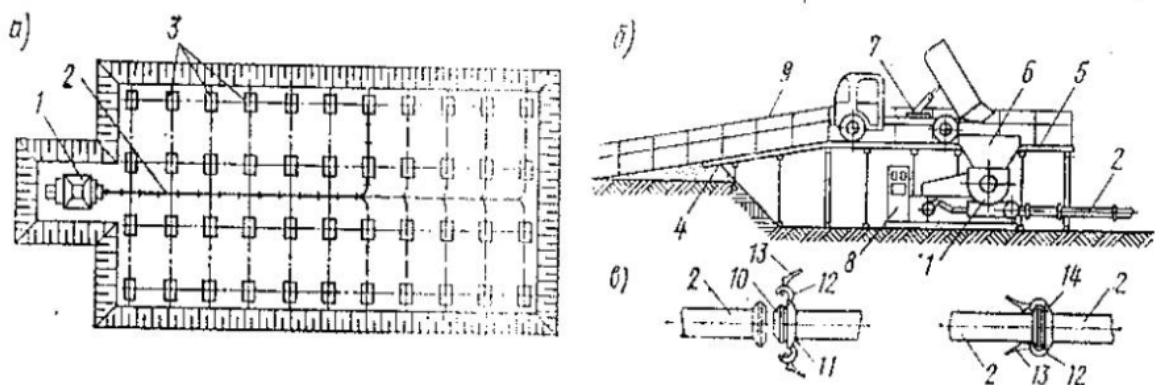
Подача бетонної суміші бетононасосами
